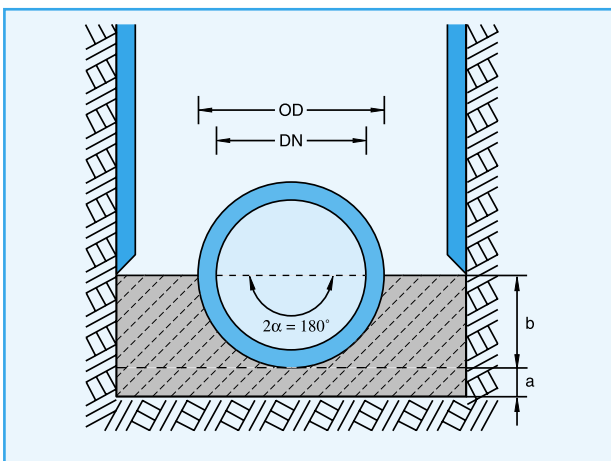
Betonbettung für Rohre mit Fuß auf Mörtelschicht
